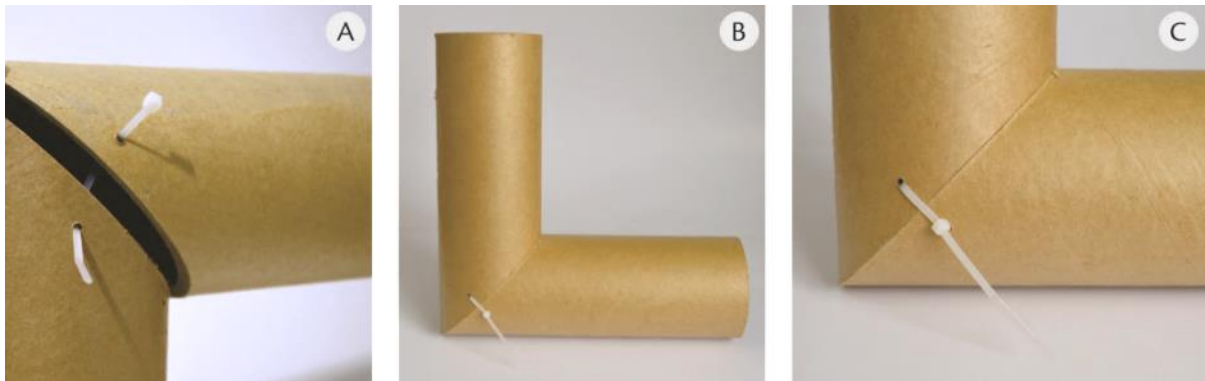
União de quina com abraçadeira. (A) Detalhe da abraçadeira aberta; (B) União finalizada; (C) Detalhe da abraçadeira fechada.
